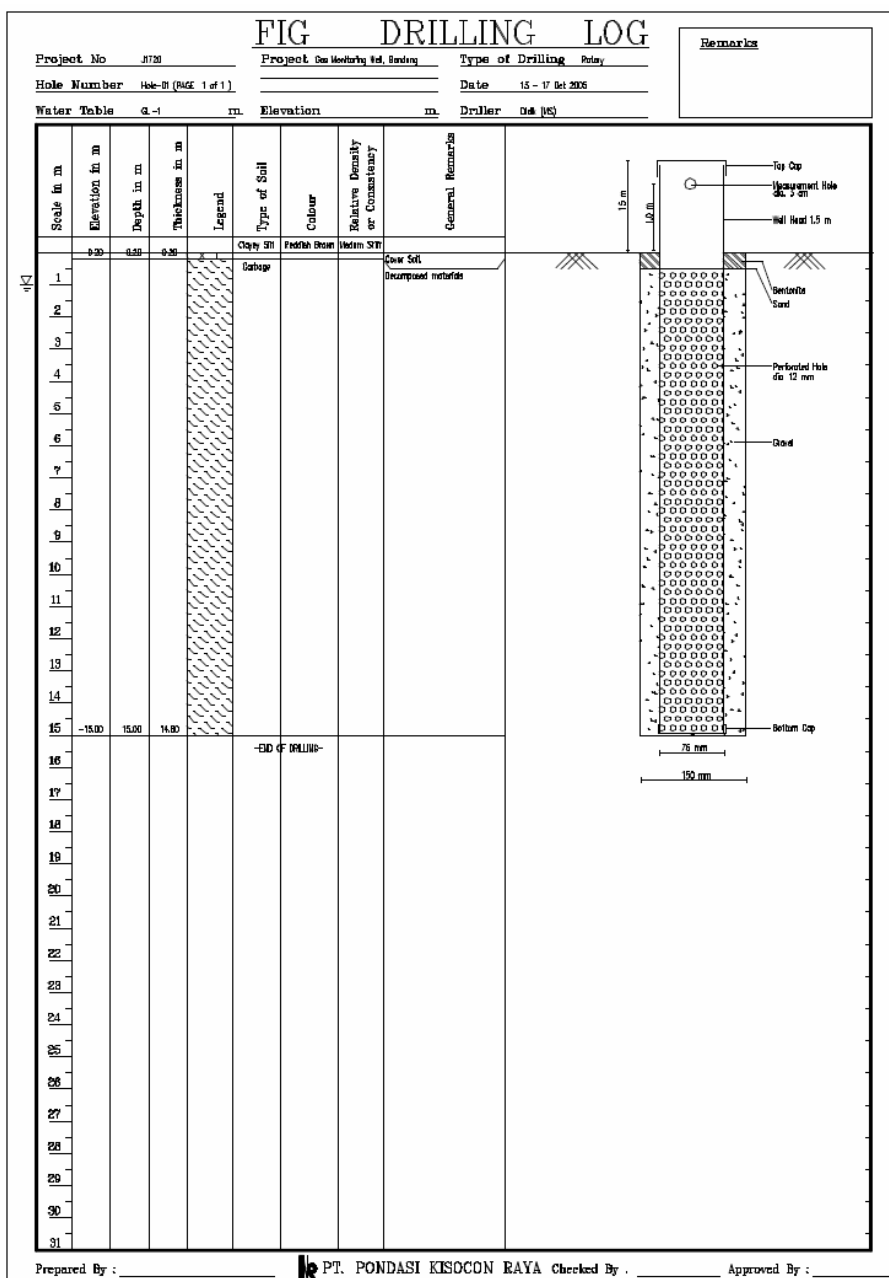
ガス測定用ボーリング断面図 (No.1 箇所)
